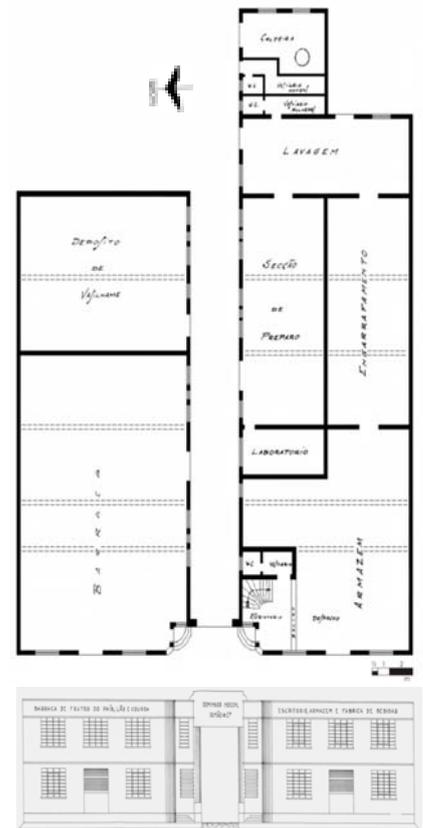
Domingos Nocchi & Irmão. Planta baixa e Fachada.
